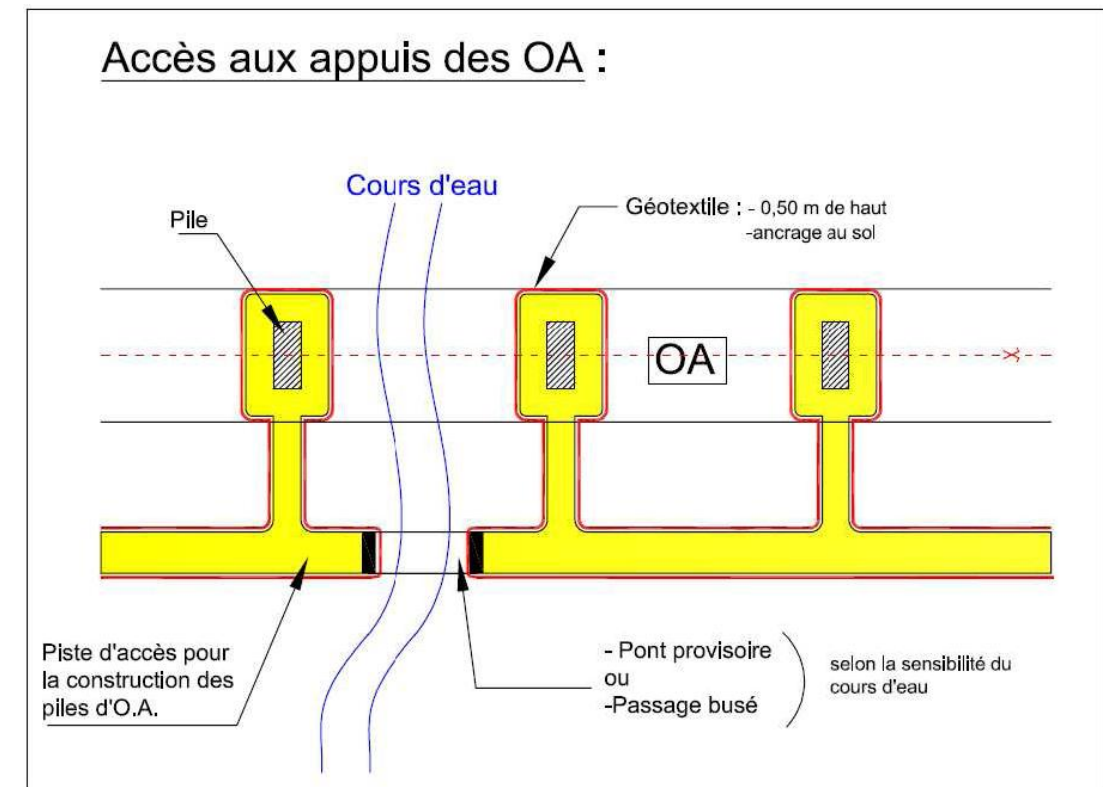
Schéma d'implantation de piste pour construction d'un ouvrage d'art
